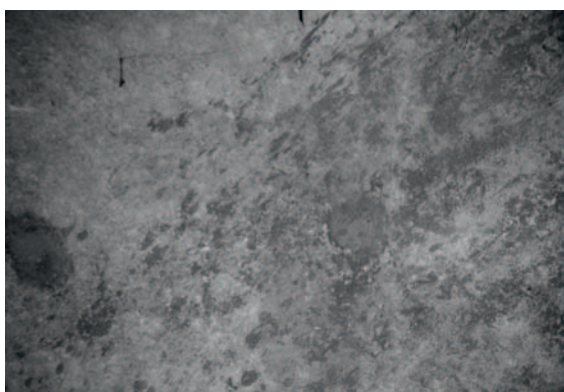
Écaillage sur parement décoffré, dû à un mauvais choix d'agent démoulant
